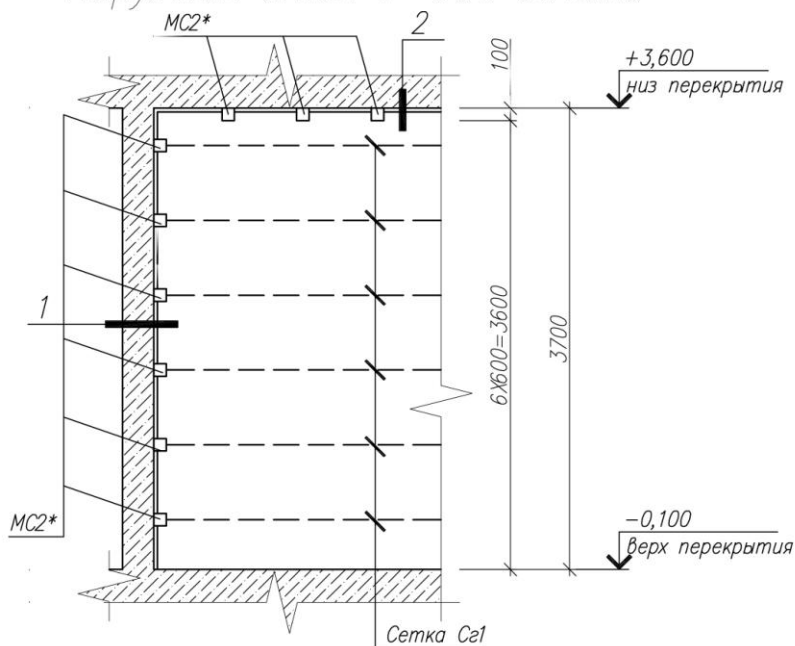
Схема узла крепления наружных стен 1 этажа из керамзитобетонных блоков
